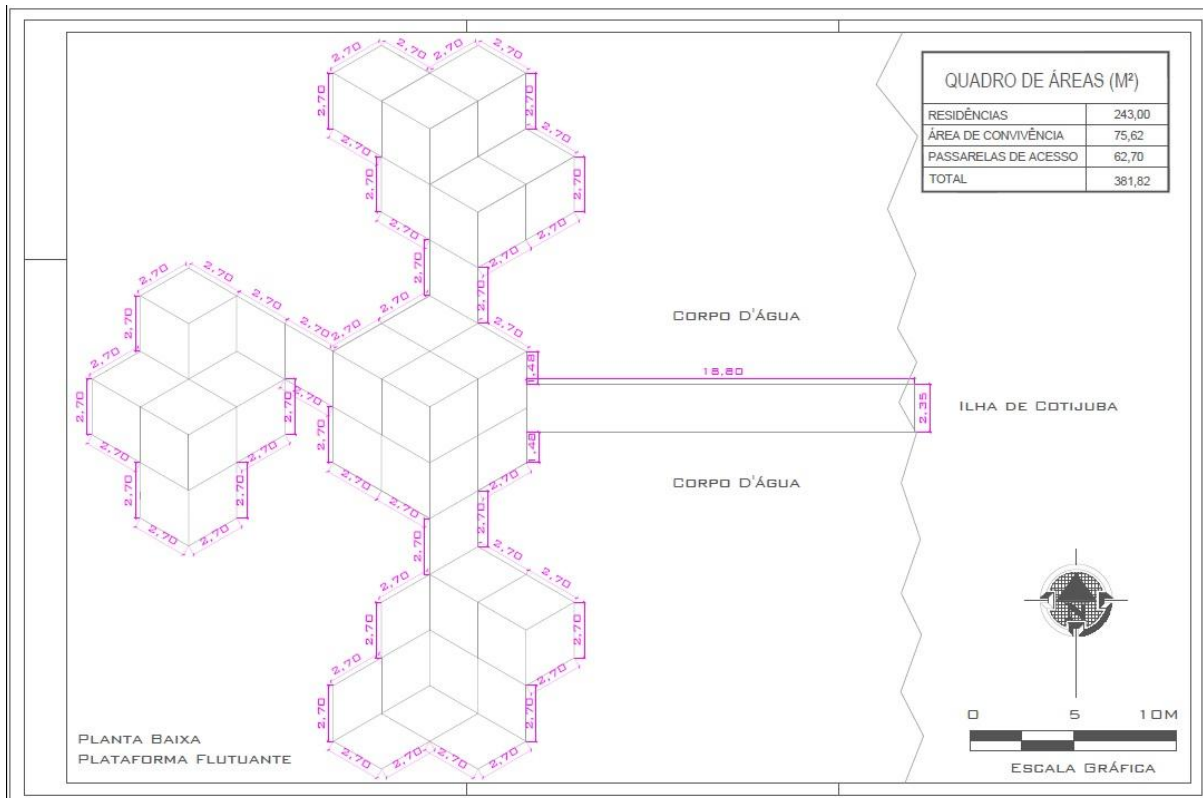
Planta baixa da plataforma flutuante. Acervo do autor.
